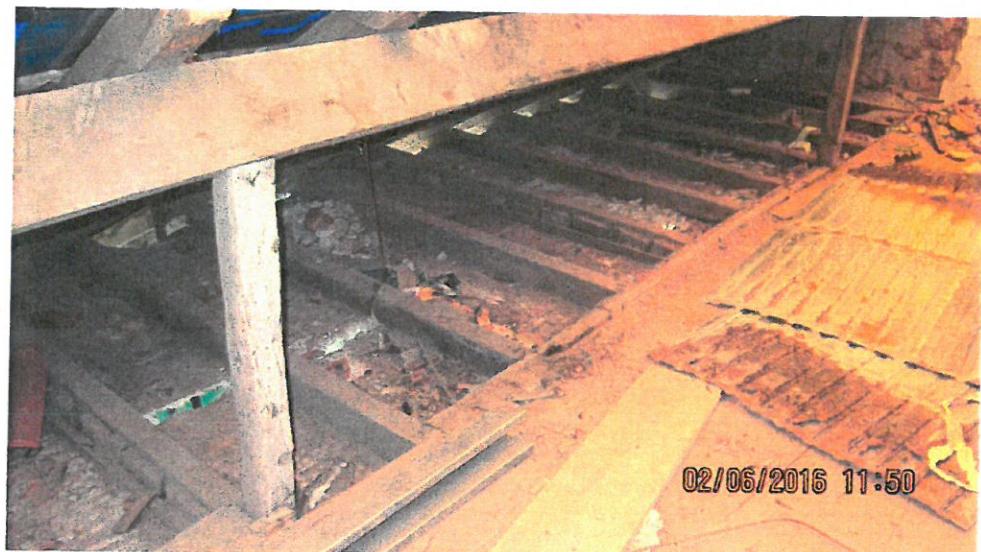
Perfis metálicos colocados sobre a cobertura de madeira. Vigas do pavimento do sótão que rematam nas pernas das asnas
